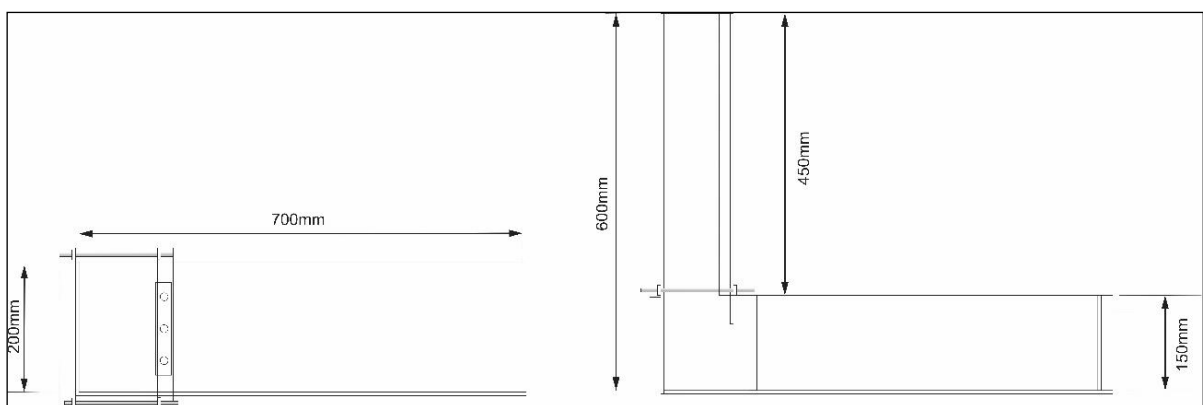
Caixa L (a) Planta (b) Vista Lateral
